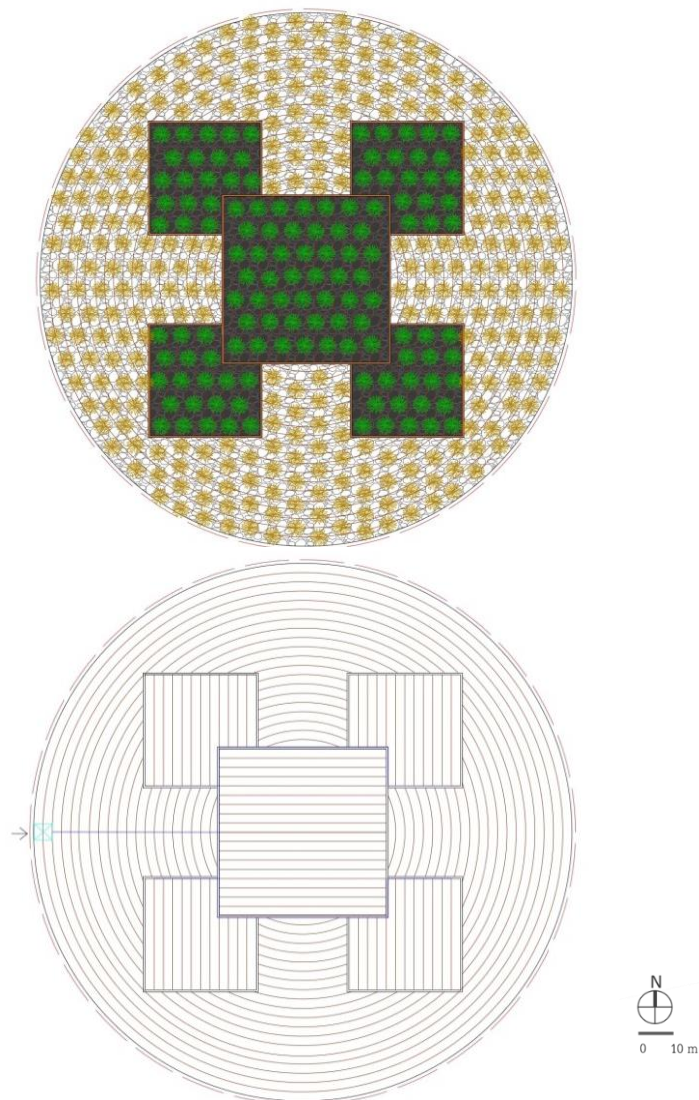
Plano pormenor da rotunda – Corte transversal (cima) e longitudinal (baixo) (Fonte: autor)
